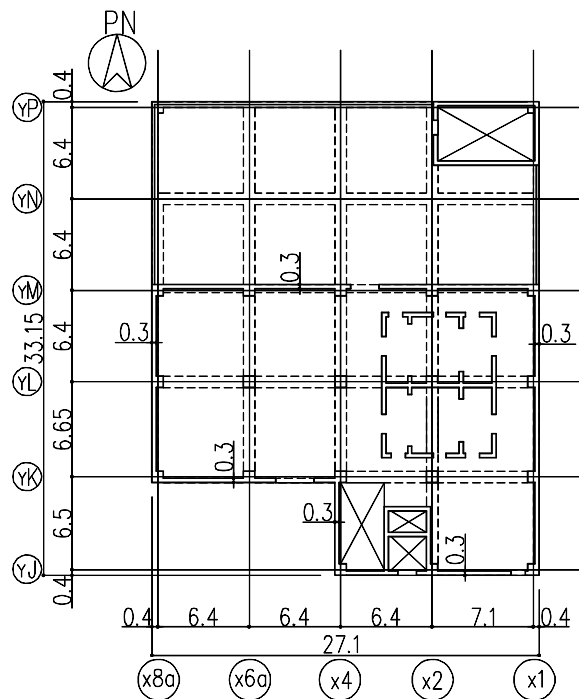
塔屋階平面図 (G.L.+11.0) (单位:m)
